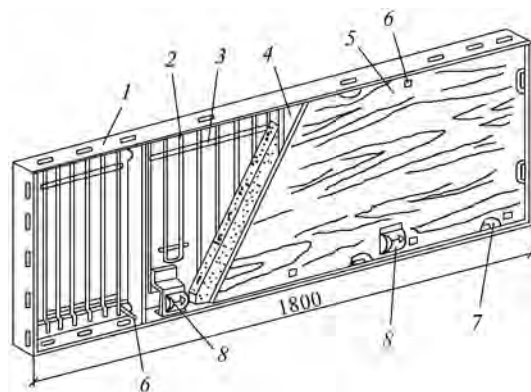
греющий щит опалубки: 1 — каркас щита; 2 — греющий кабель; 3 — скоба крепления кабеля; 4 — утеплитель; 5 — защитный кожух; 6 — крепления кожуха; 7 — вырез для установки и крепления щитов; 8 — вилочный разъем щитов
